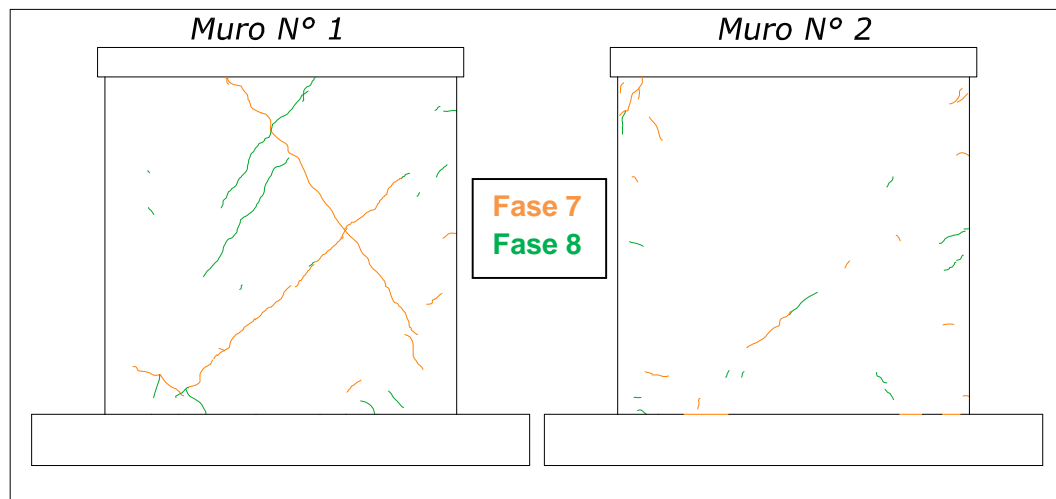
Fisuras en las Fases 7 y 8
